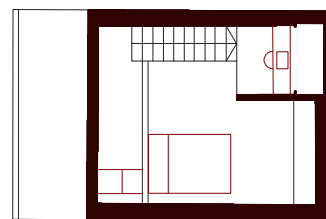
Planta superior tipo A Ilha da Bela Vista - LAHBSocial
